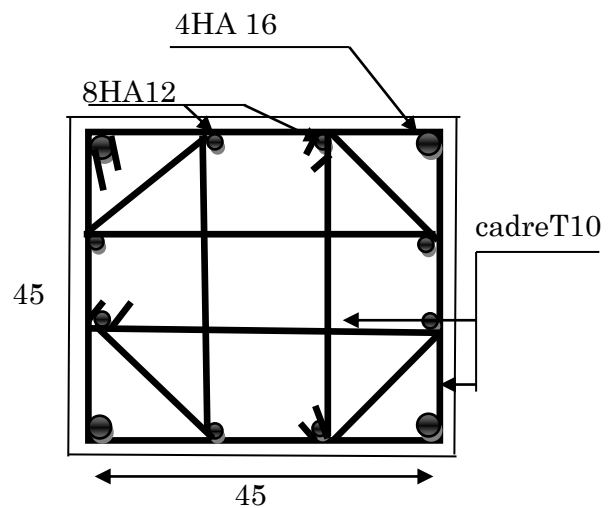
Schéma de ferrailage des Poteaux RDC et 1^{er} étage
